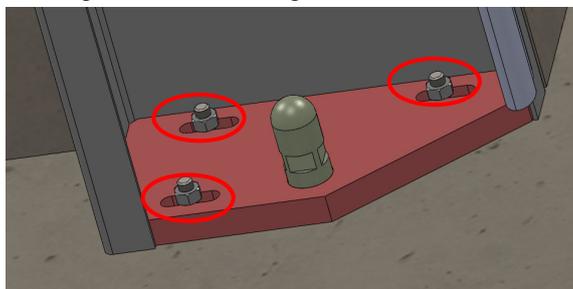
Verdübeln / verschweißen / verschrauben der Bodenplatte
